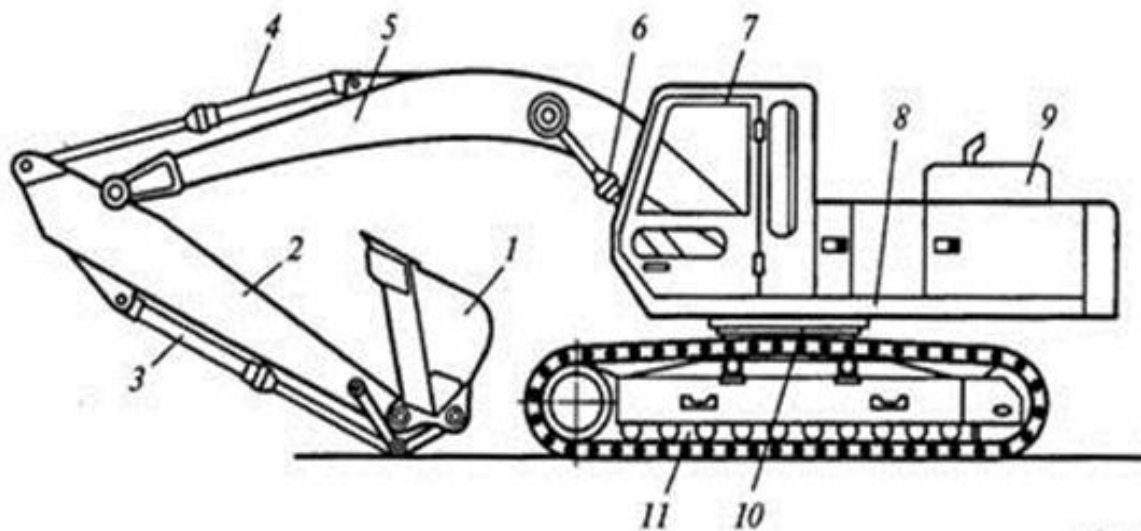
Одноковшовый полноповоротный гусеничный экскаватор ЕК-270: 1. ковш; 2. рукоять; 3, 4, 5. гидроцилиндры; 6. стрела; 7. кабина оператора; 8. поворотная платформа; 9 - силовая установка; 10 - опорно-поворотное устройство; 11. гусеничное ходовое устройство
